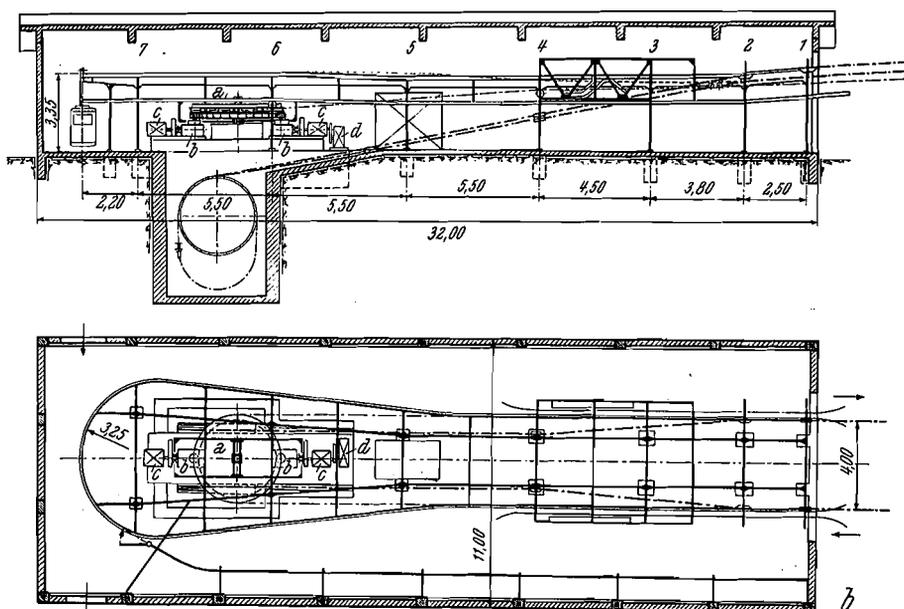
Bergstation einer Personenseilschwebebahn mit Umlaufbetrieb
